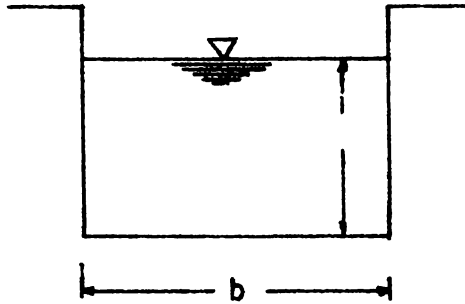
Schéma de la section transversale d'un canal rectangulaire.
